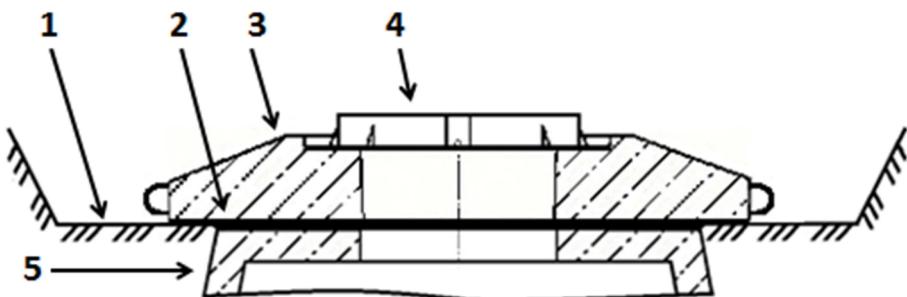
Плита ОП-1к-У установлена на перекрытие колодца при новом строительстве.
